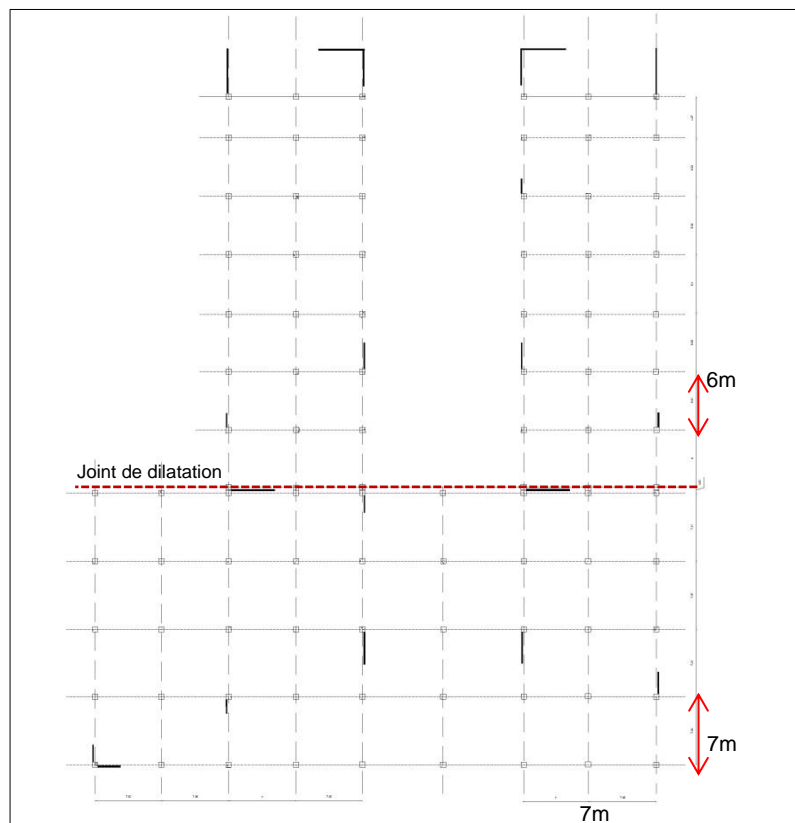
Plan de structure de l'hôpital- système poteaux poutres
